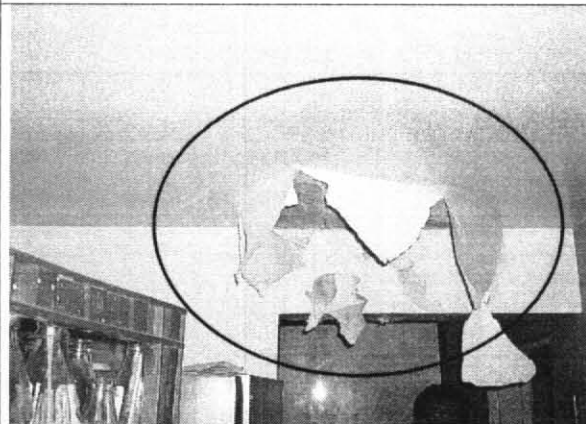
Desprendimiento de acabados en algunos sectores de la cubierta.
